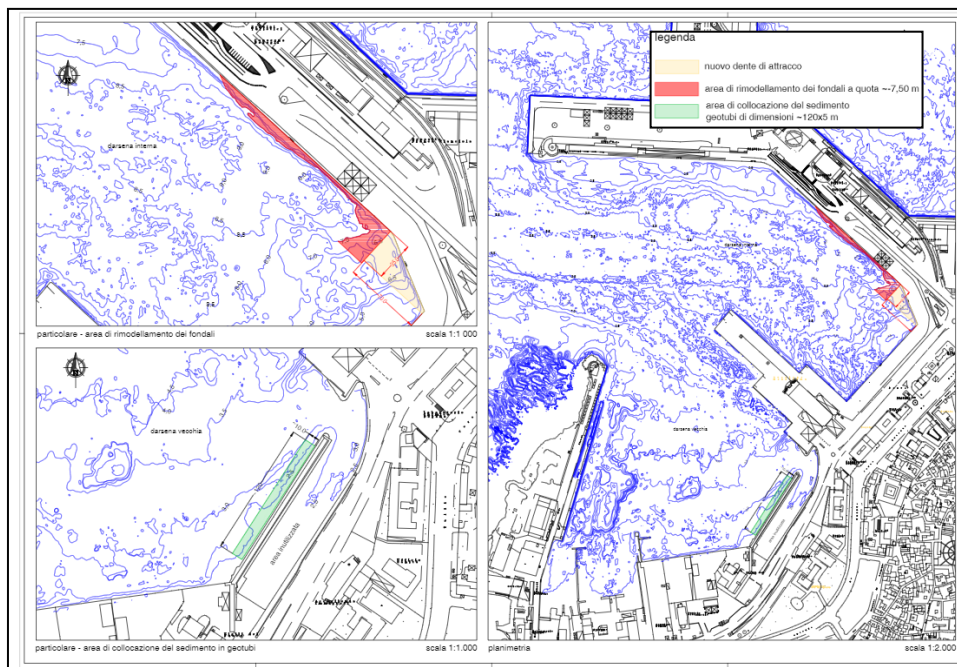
Stralcio Elaborato 3.2 – Rimodellamento dei fondali – Spostamento dei sedimenti in ambito portuale – progetto definitivo
